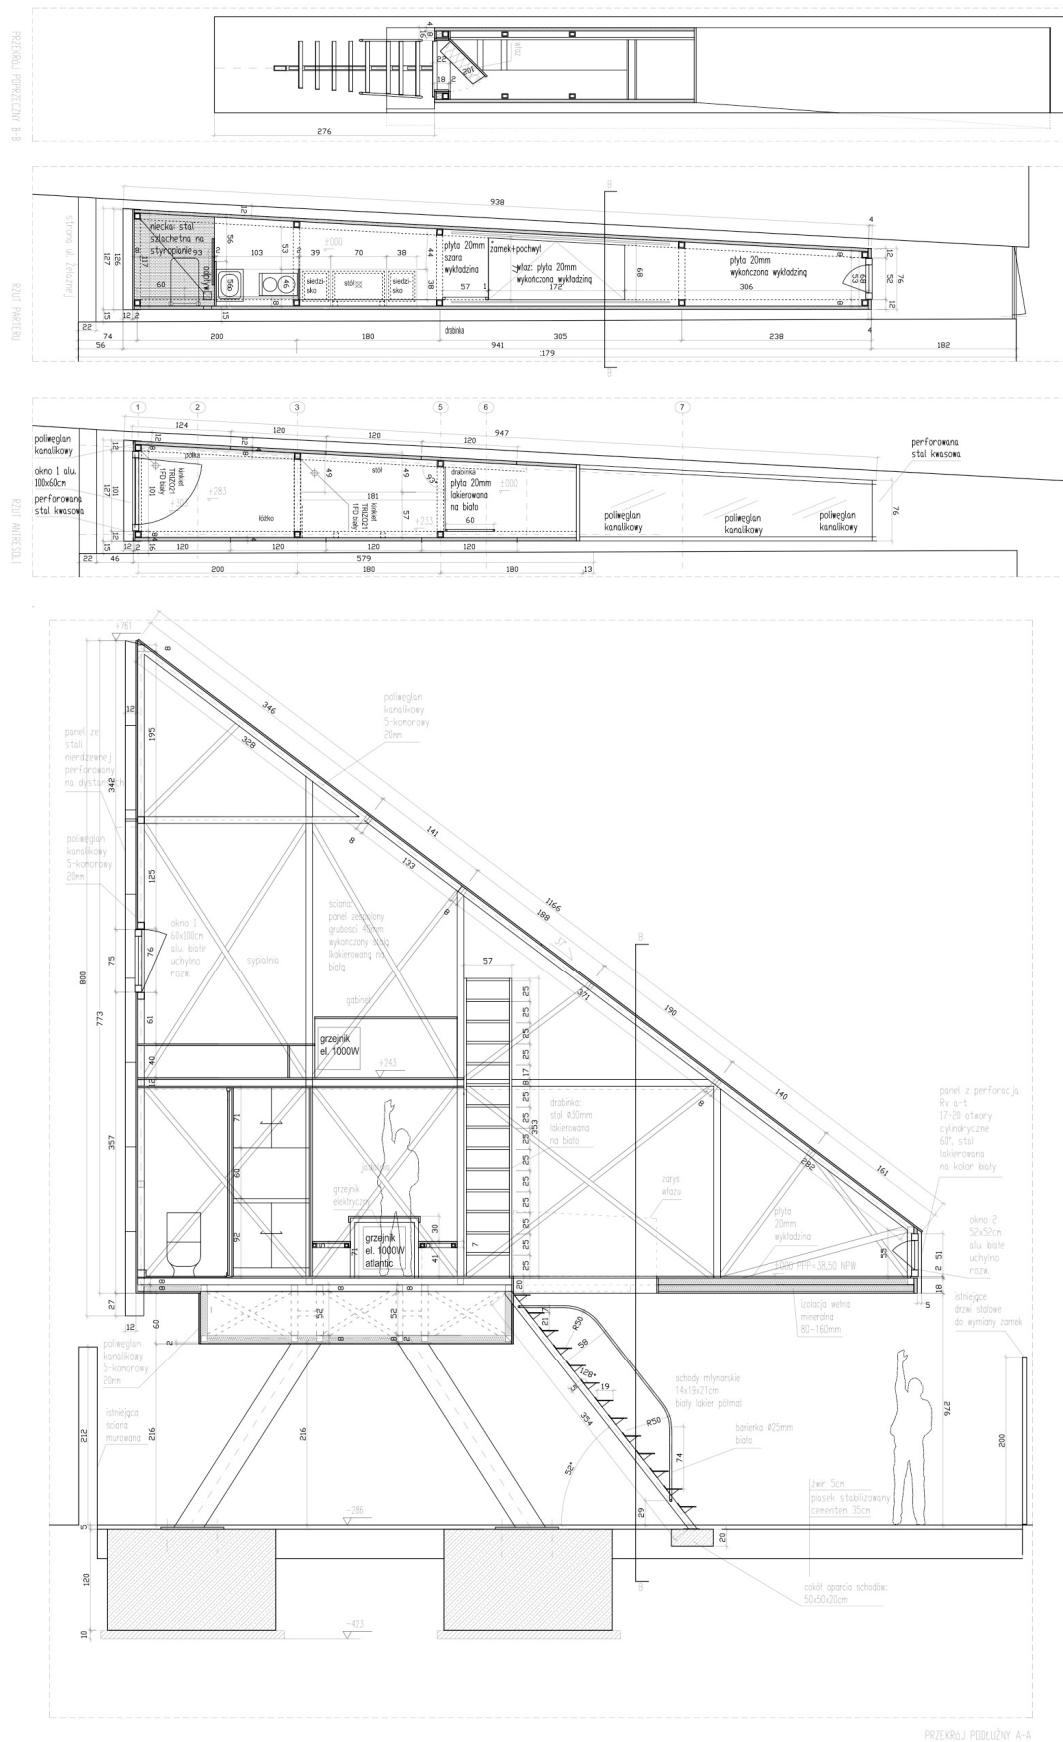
Plantas do Piso de acesso, piso 1 e piso 2 e Corte da Keret House (Courtesy of Centrala, 2012)
